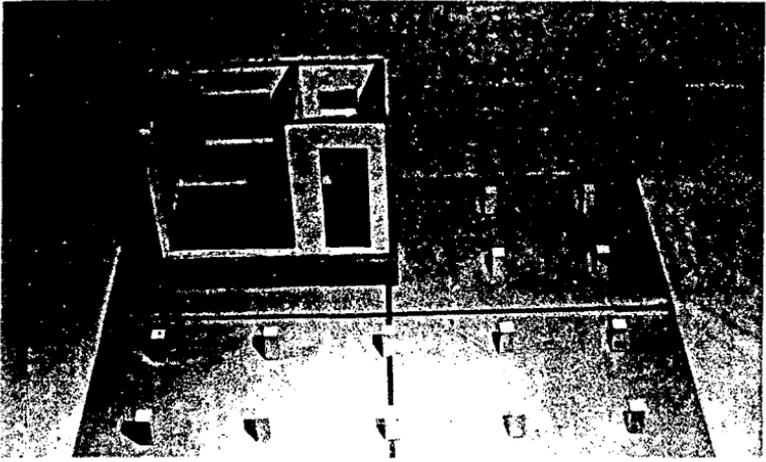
Núcleo de alvenaria com pilaretes construídos.
